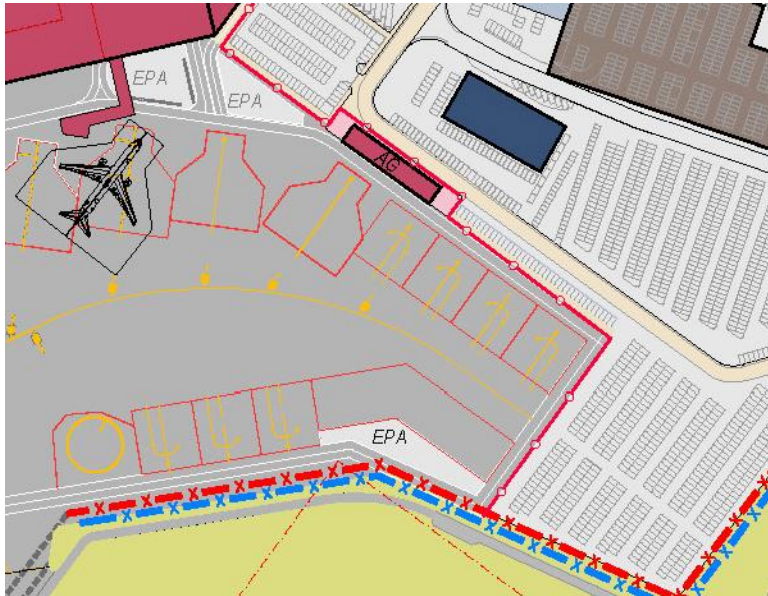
Planimetria piazzale di Aviazione Generale: nuovi stand previsti
